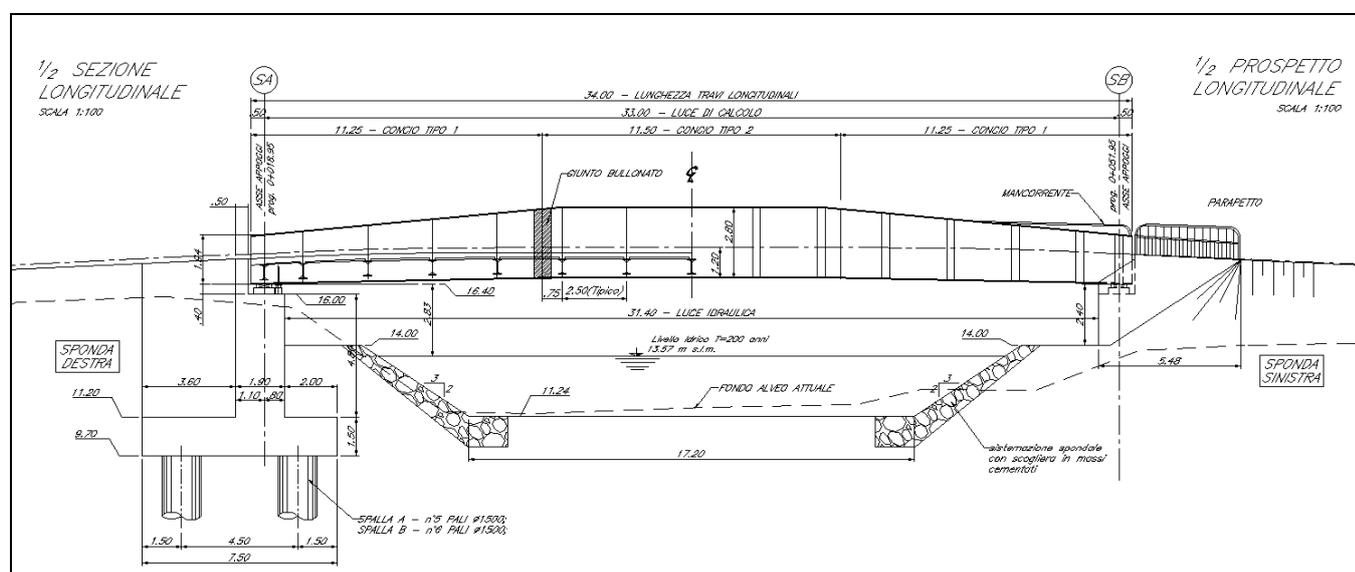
Profilo e sezione fondazioni nuovo Ponte
